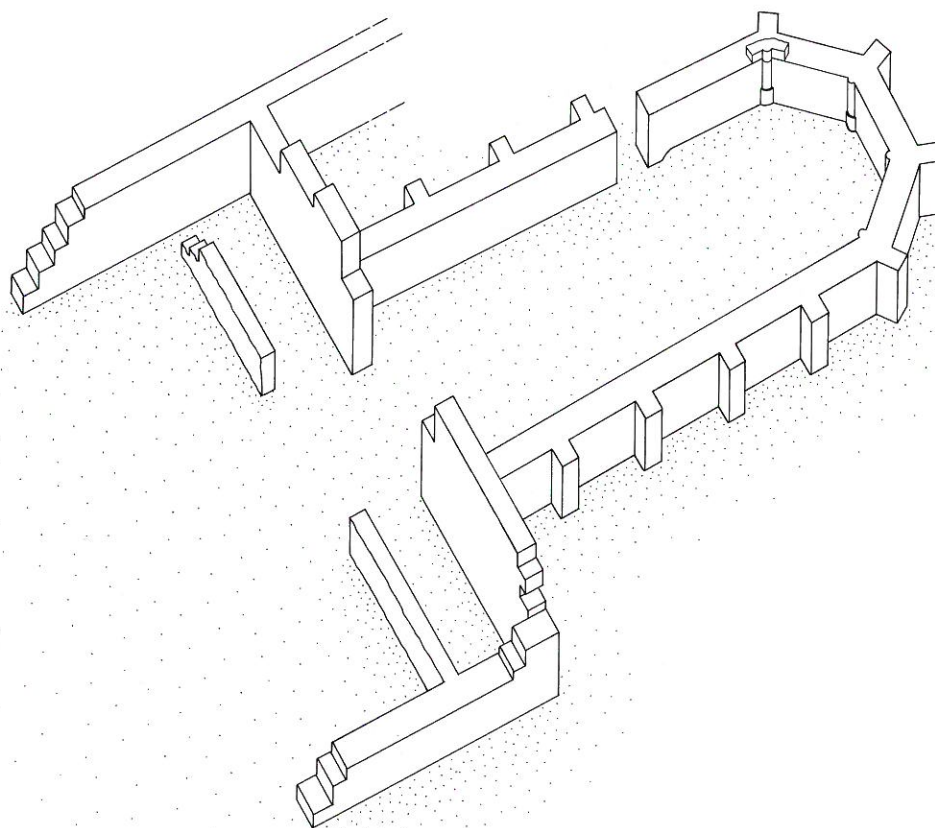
Chor und östliche Teile des Langhauses. Rekonstruktionsversuch der ersten Bauetappe von Südwesten (Massstab 1:300).
